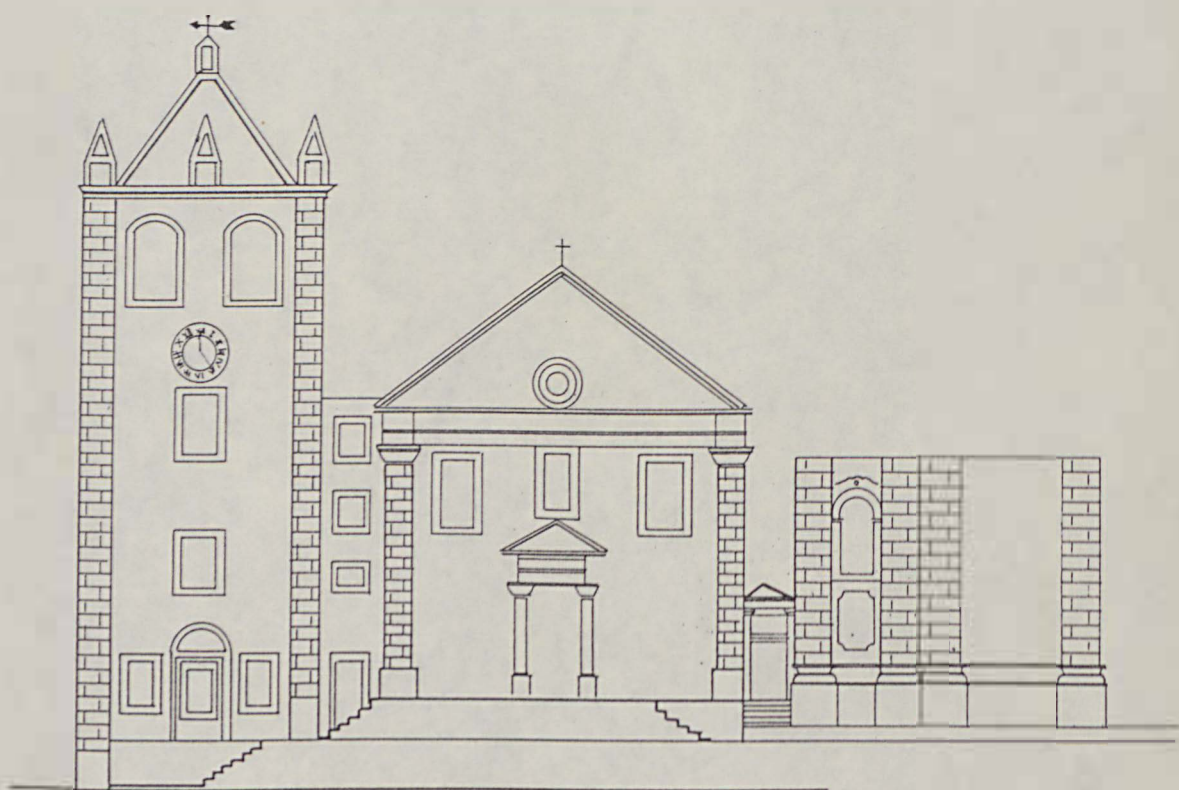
Estudo para fachada sobre o Levantamento do Hospital Militar da Corte -
